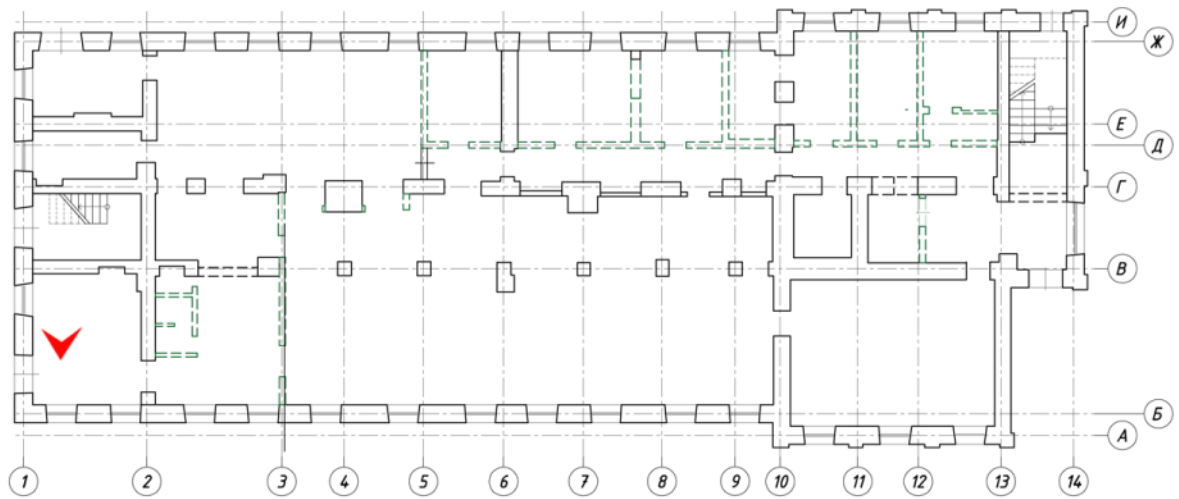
Помещение 1-го этажа в осях 1 – 2/Б – В.
